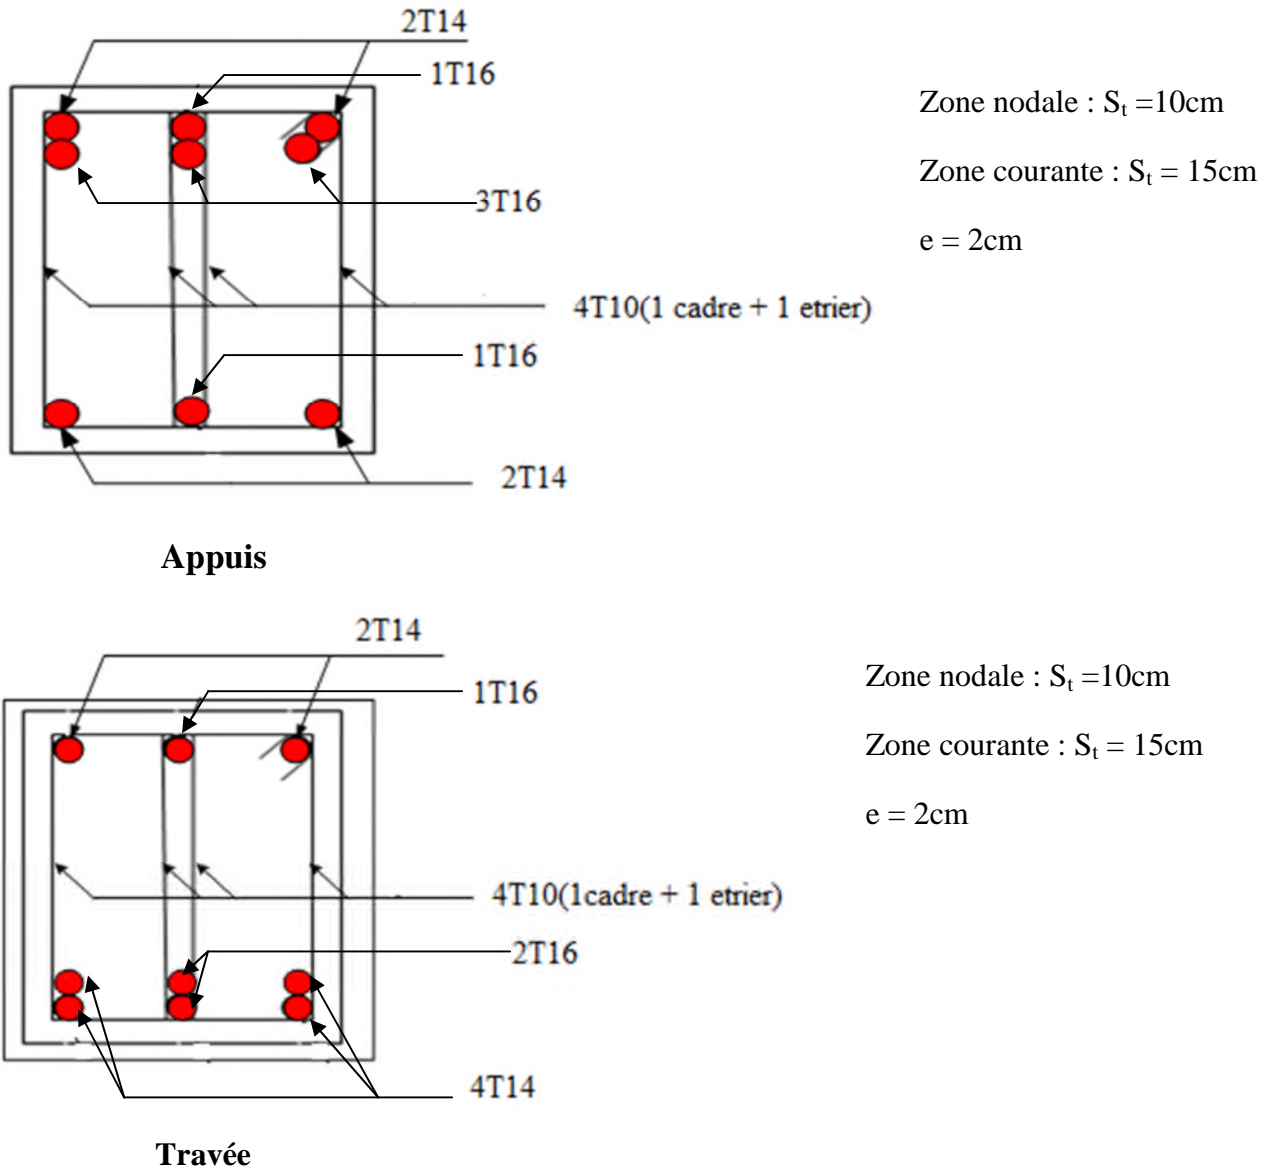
Schéma de ferrailage des poutres secondaires du RDC,1,2,3,et 4^{ème} étage.
